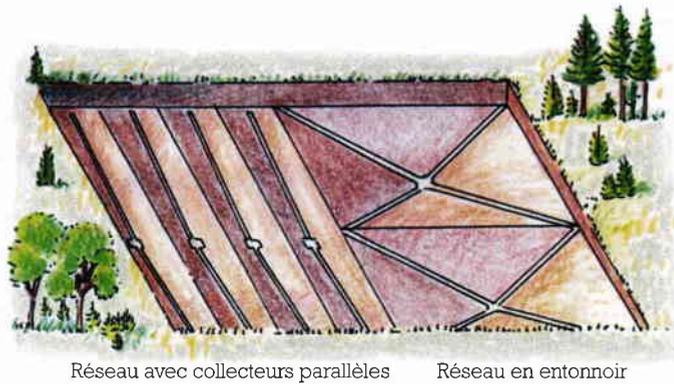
Modélisation d'un toit de remblai plat pour évacuer les eaux d'infiltration [5].
